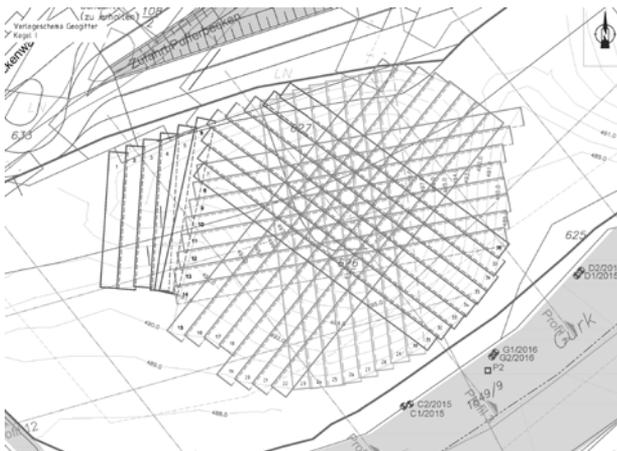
Verlegeplan untere Bewehrungslage am Kegel 1.
